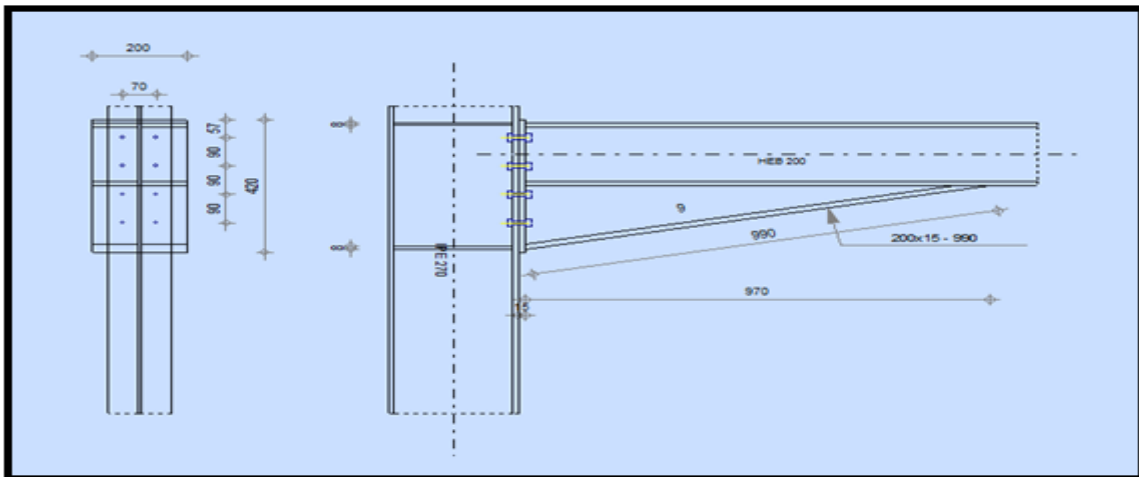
Vue en plan de l'assemblage poteau- console de la poutre de roulement
